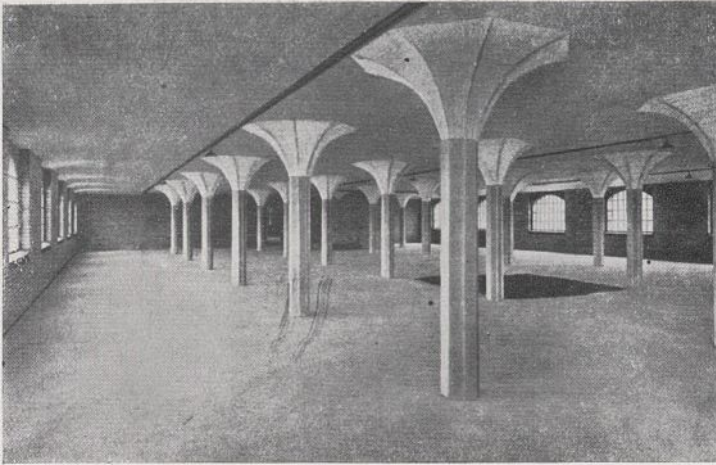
Zürich-Gießhübel, Lagerhaus. Pilzdecke.
